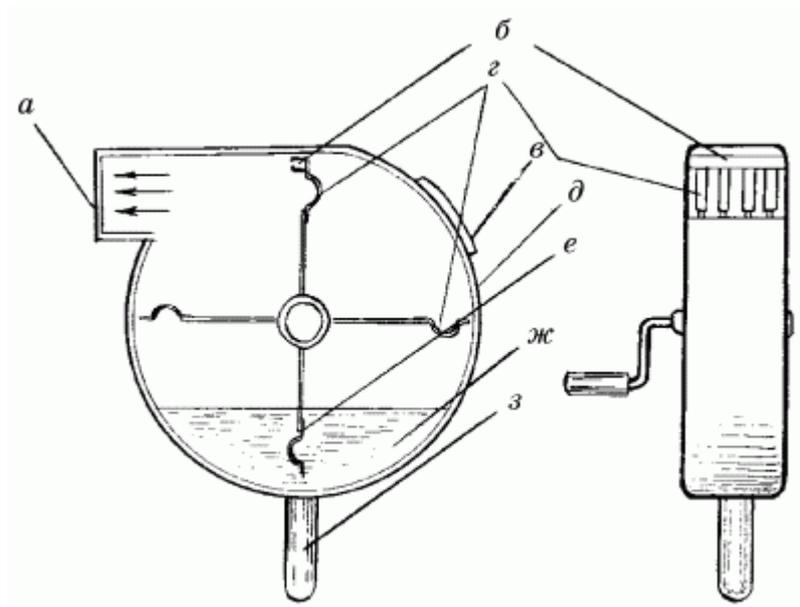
Приспособление для набрызга декоративной штукатурки: а – выходное отверстие; б – упор; в – отверстие для заливки раствора; г – захваты; д – корпус; е – ротор; ж – раствор; з – ручка.
